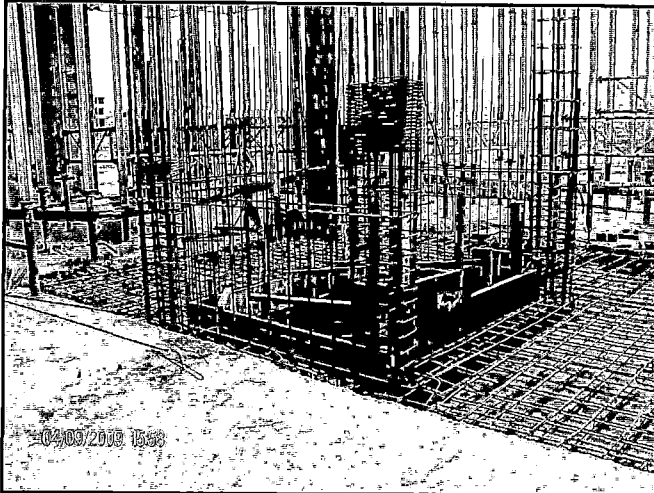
CAJA DE MONTACARGAS Y ARMADURA DE ACERO DE LOSA SUPERIOR.
